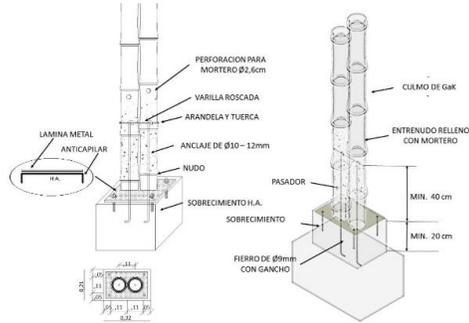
Anclaje mediante varillas de acero (Plancha metálica).
